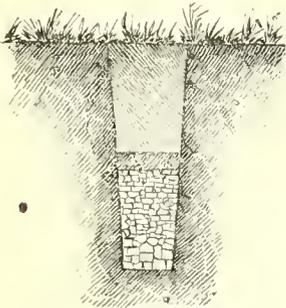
Coupe en travers d'un drain à pierres perdues.
